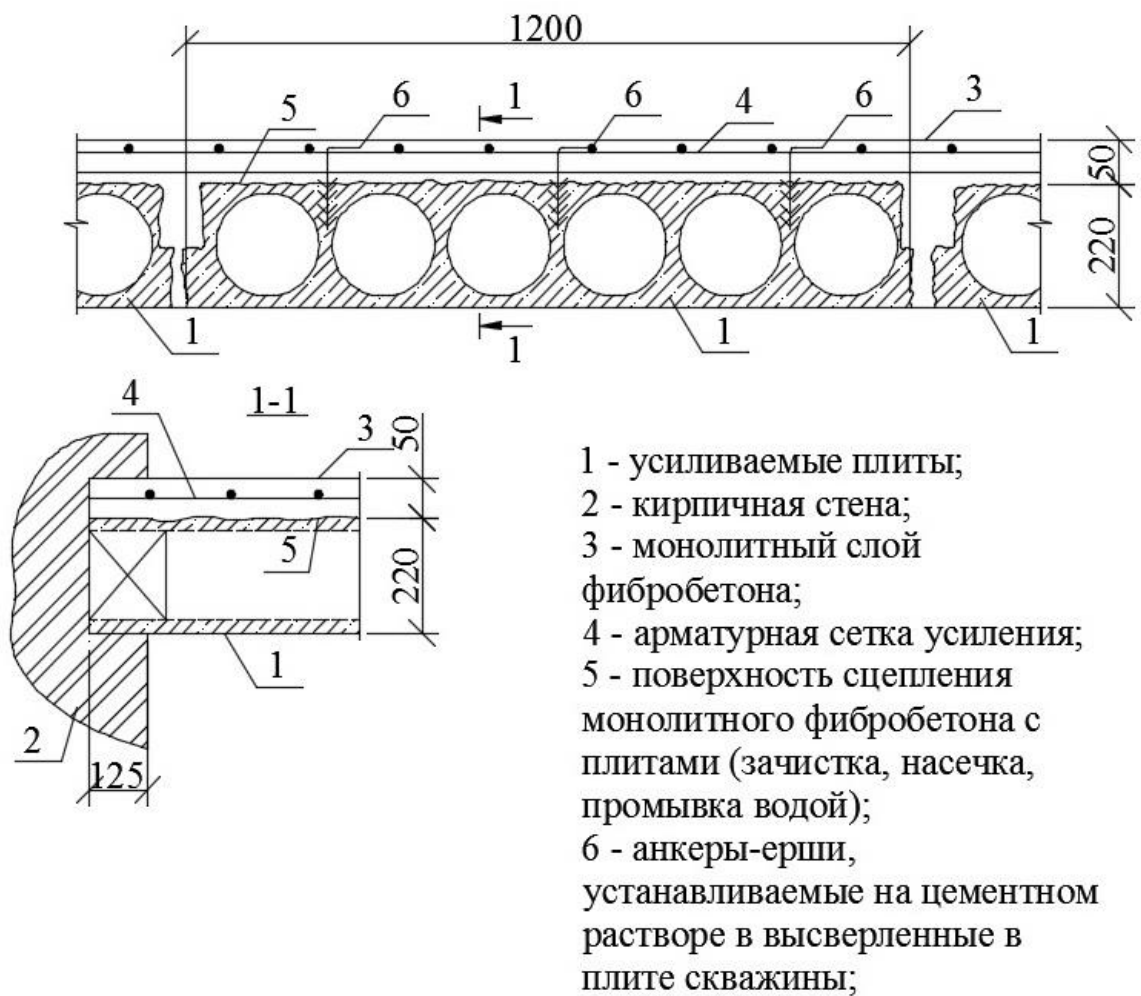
Вариант усиления многопустотной плиты перекрытия наращиванием сжатой зоны сталефибробетоном
